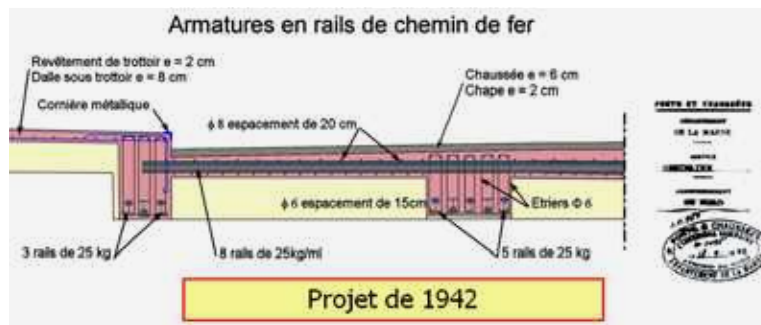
exemple d'utilisation de rails pour le ferrailage d'un pont
